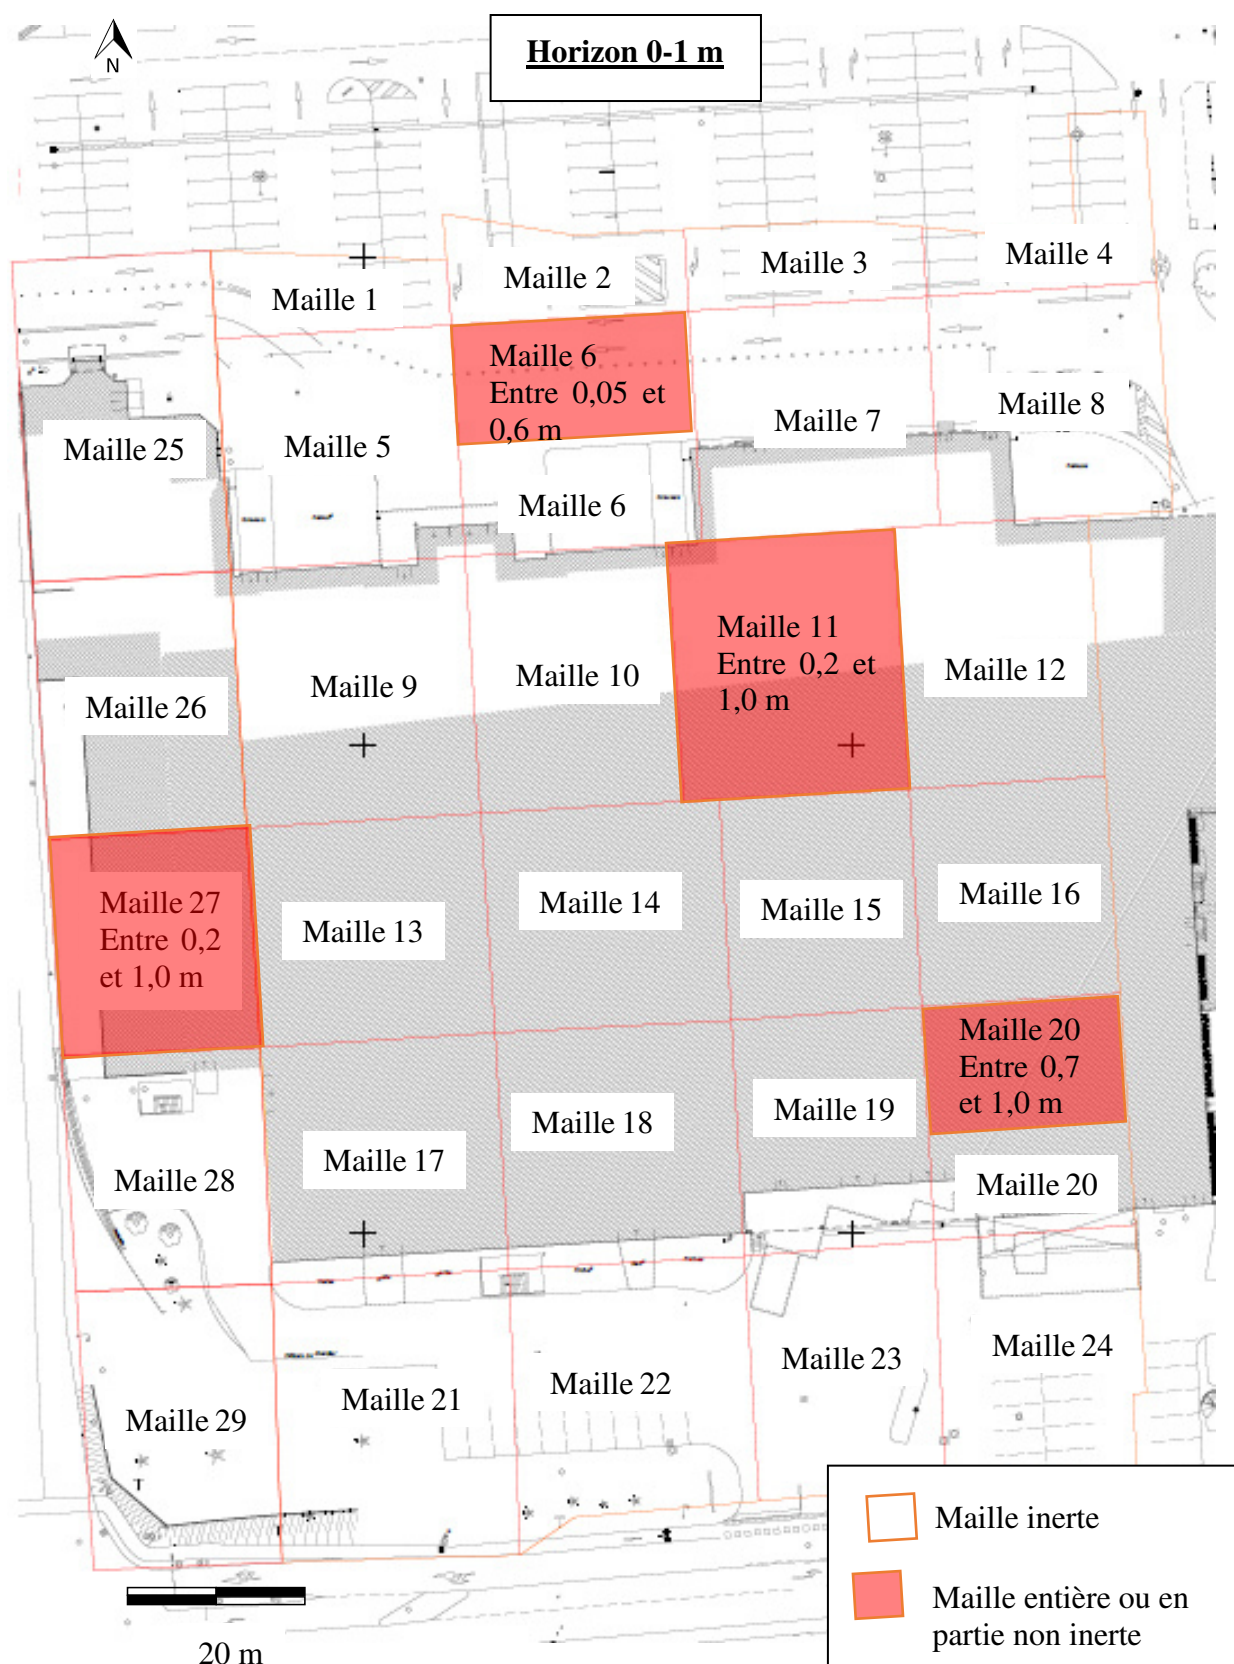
Plan de maillage présentant le caractère inerte des terres sur l'horizon 0 à 1 m de profondeur
